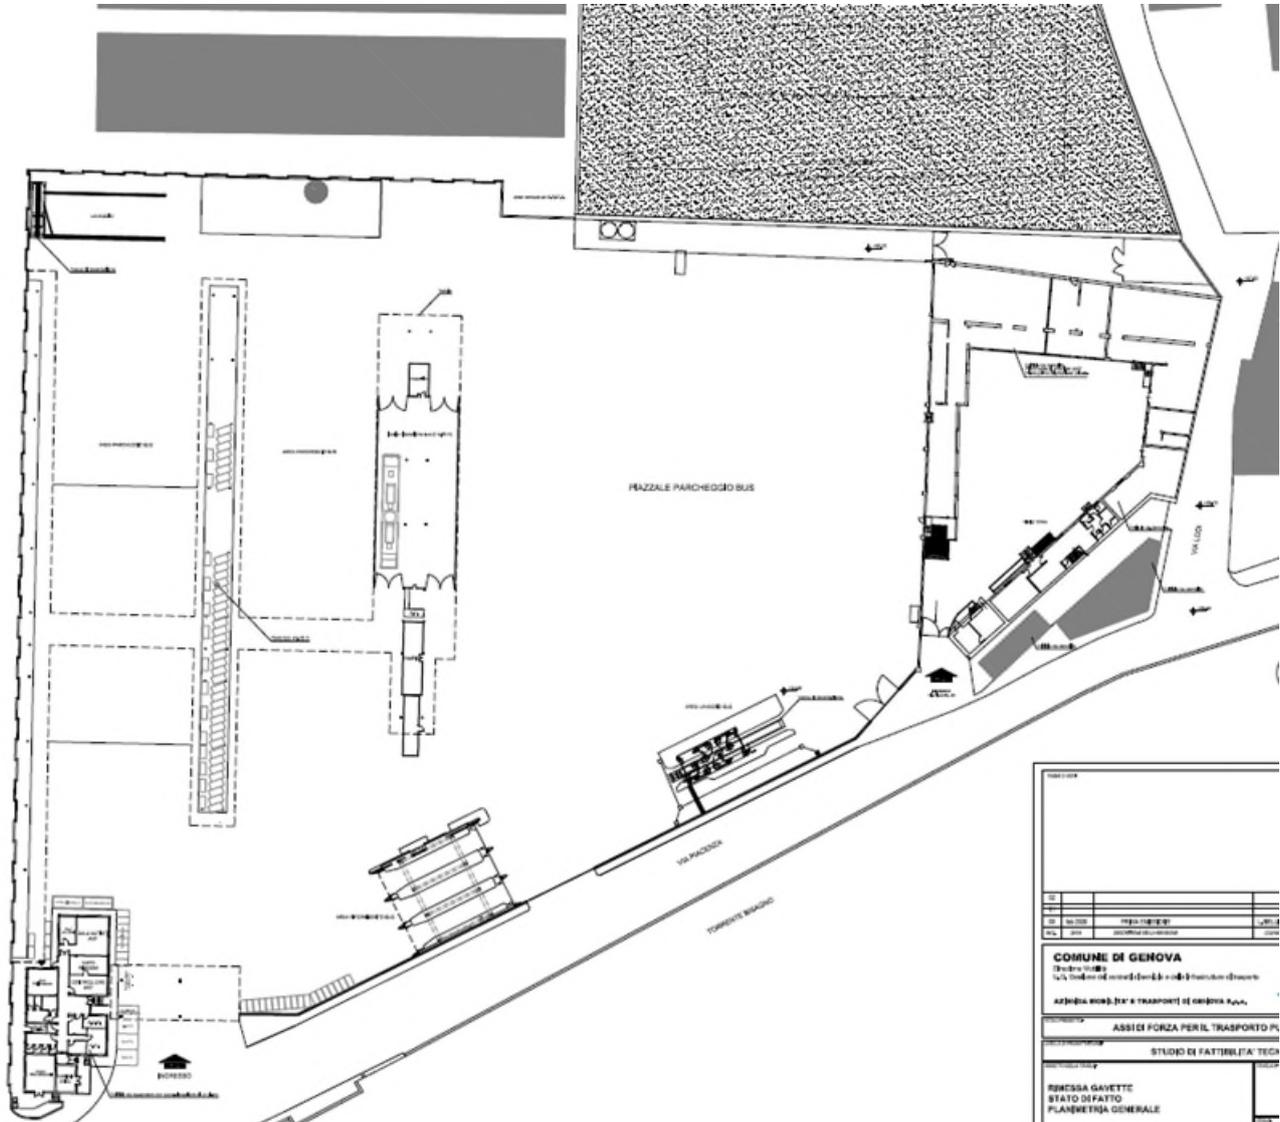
Estratto planimetria di progetto rimessa Gavette
